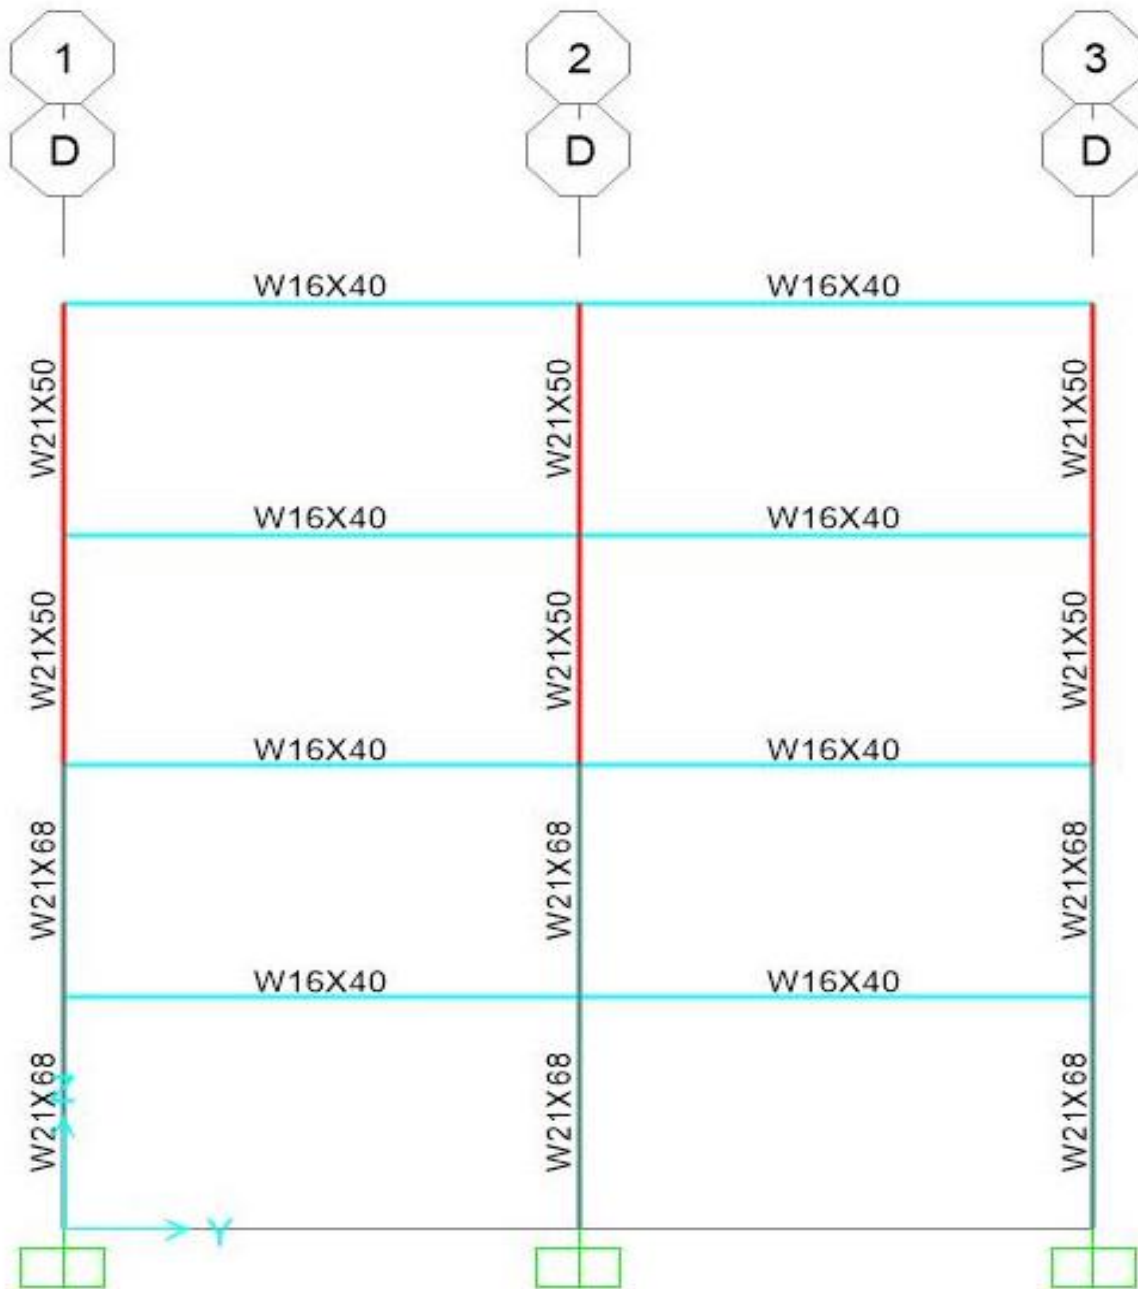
10 Elevación estructural EJE-D (Fuente propia).
